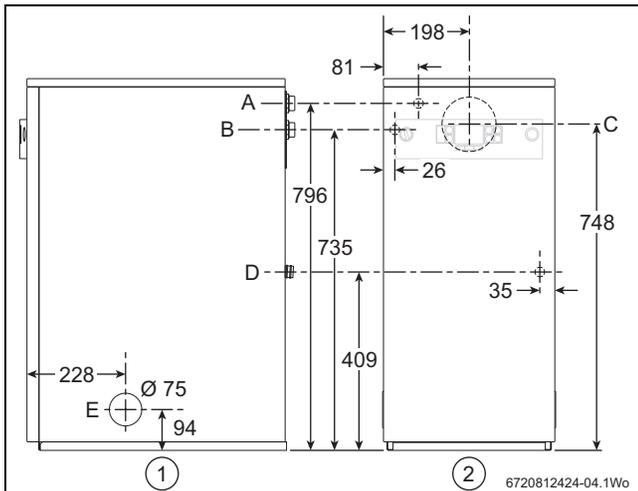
Lage der Rohrleitungen (alle Abmessungen in mm)
